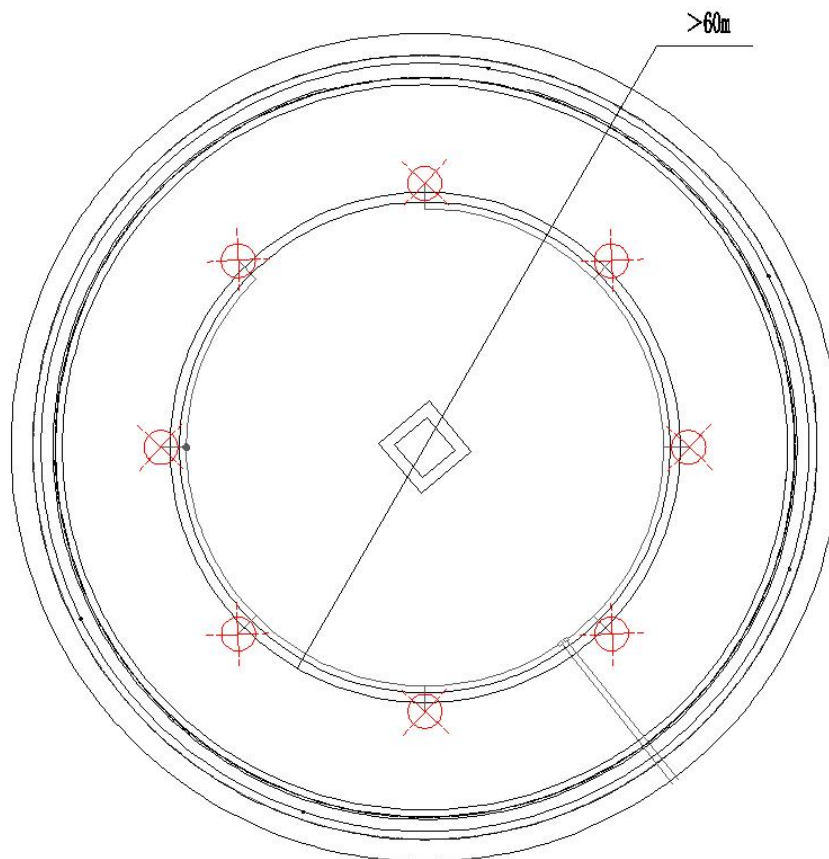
冷却塔顶部障碍灯布置平面图
